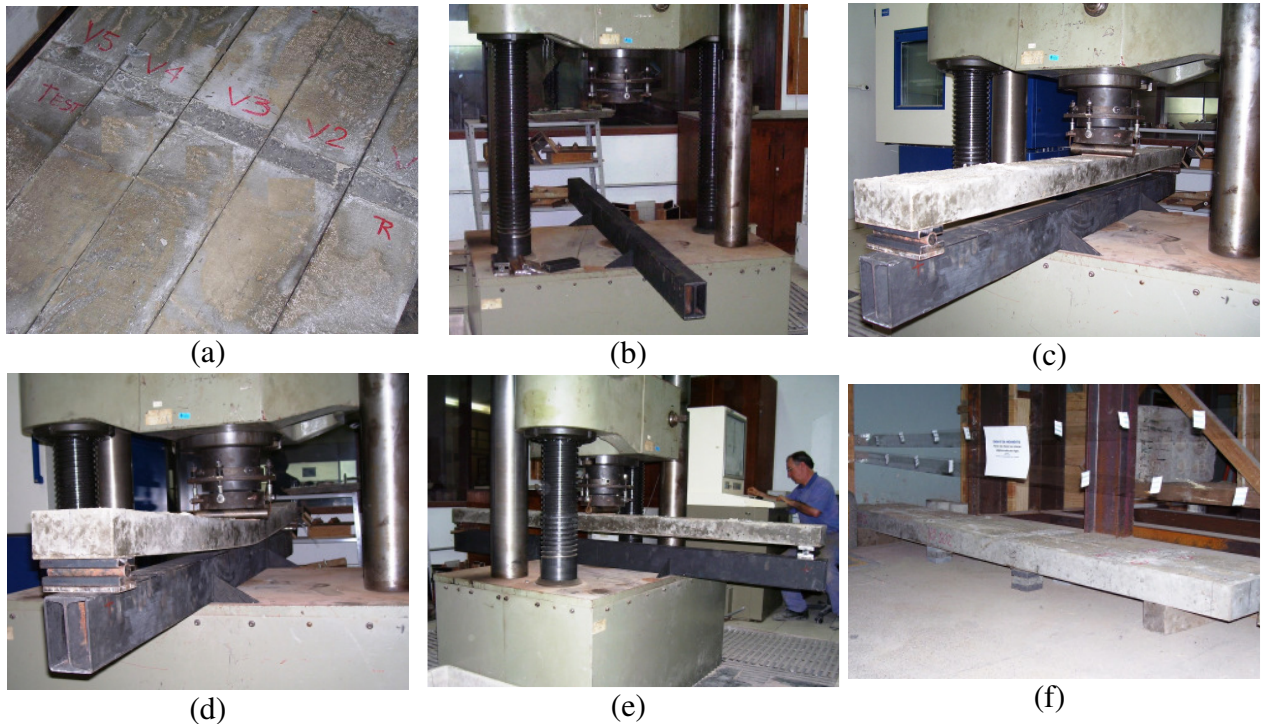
(a) vigas após a desforma, (b) perfil I sobre a prensa, (c) viga V1 antes do carregamento, (d) viga V1 no final do carregamento, (e) pré-carregamento da viga V2, (f) vigas acomodadas após o pré-carregamento.
